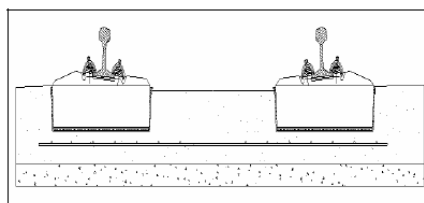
Esquema del sistema de vía en placa de bloques recubiertos de elastómero tipo Edilon.
